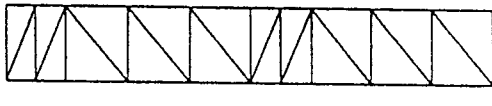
รูปประกอบคำศัพท์ SUPPORT TYPE กรณี PITCH ROOF TRUSS
